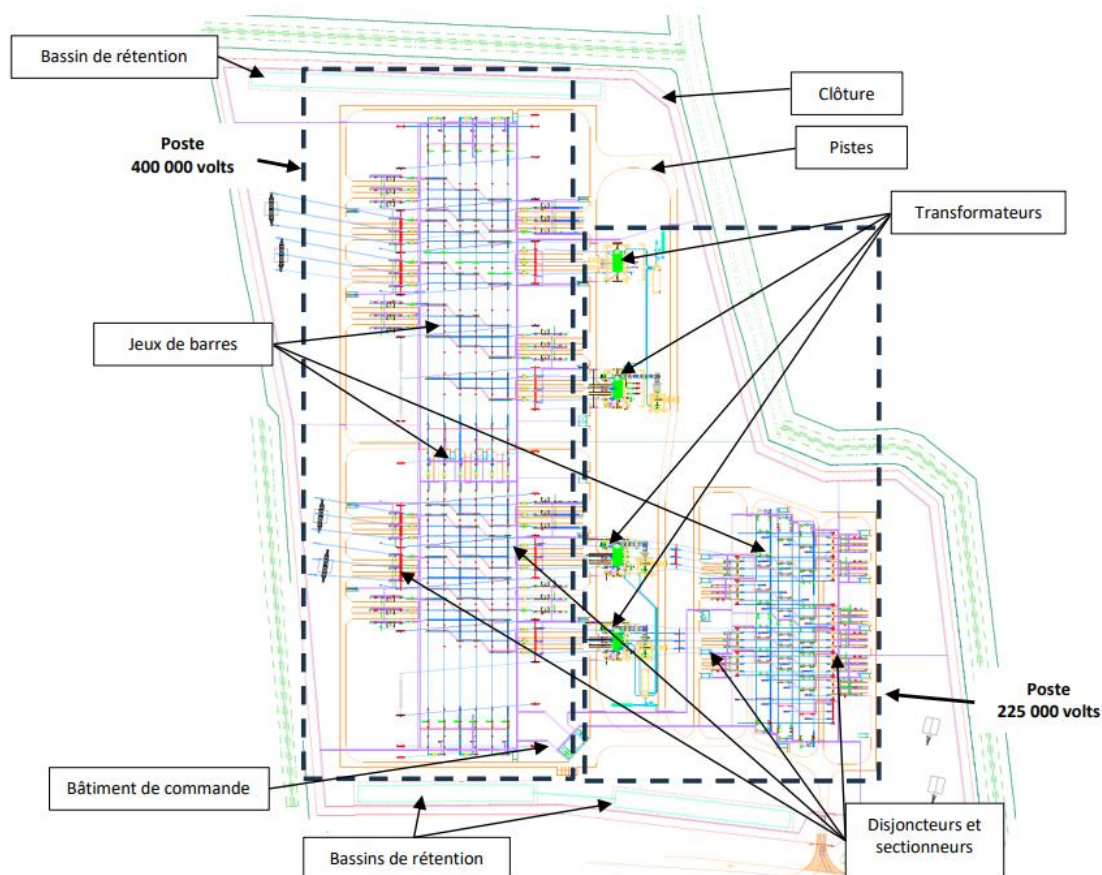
Projet de plan général des installations du poste de Puythouck (source : dossier)
